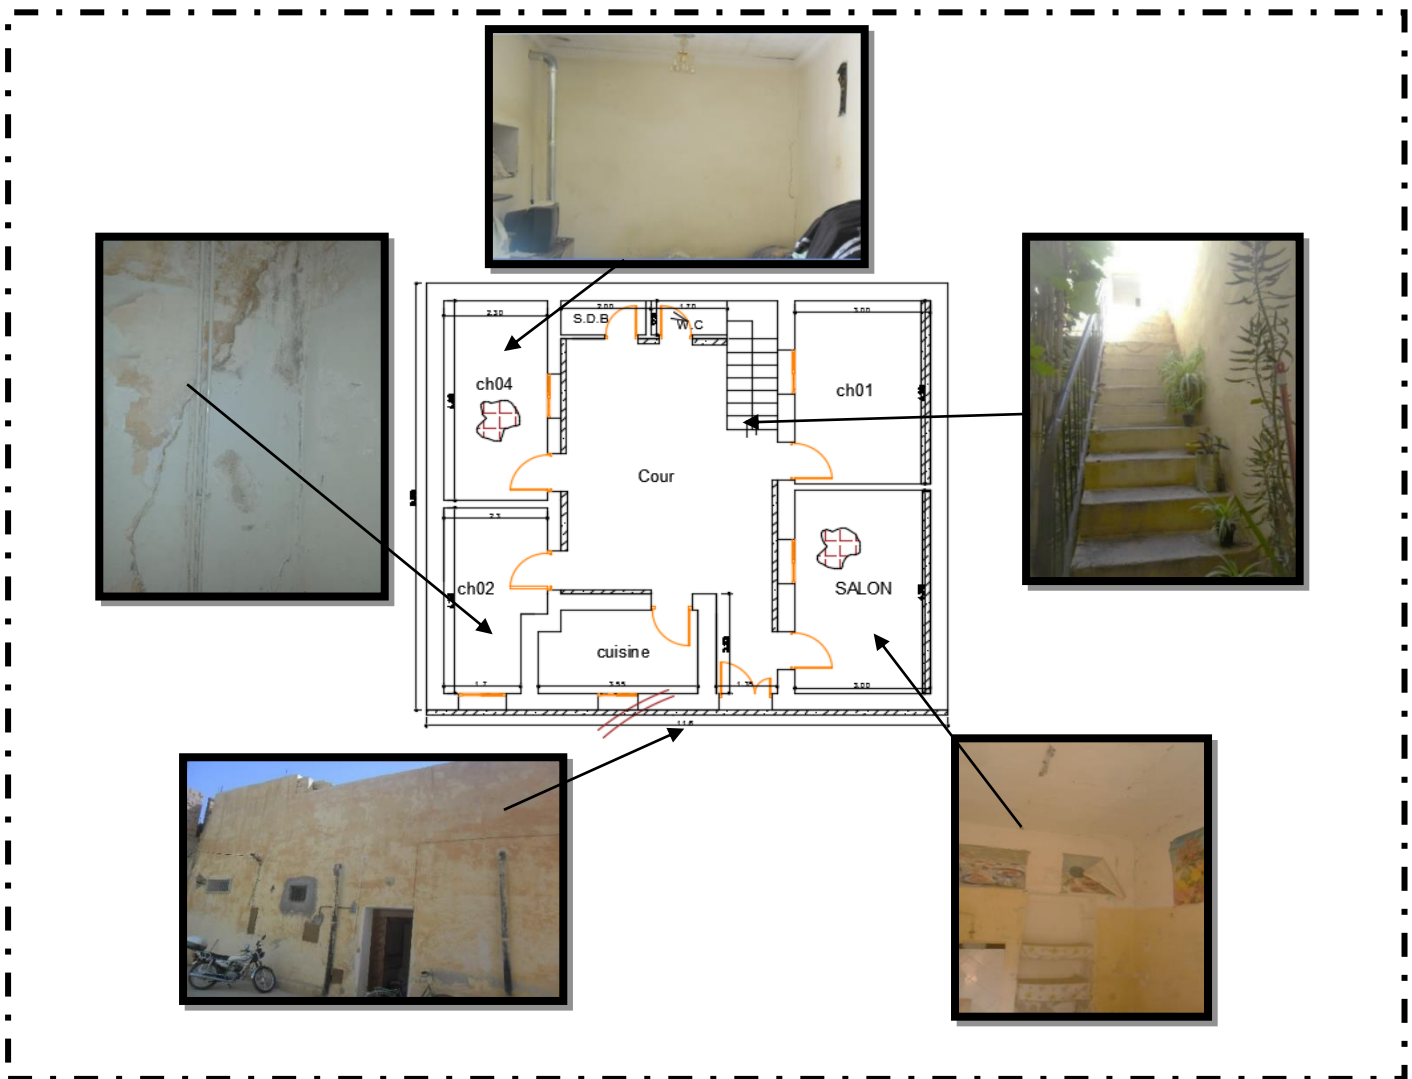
Plan état des lieux : rez-de-chaussée /Source : Etudiante
